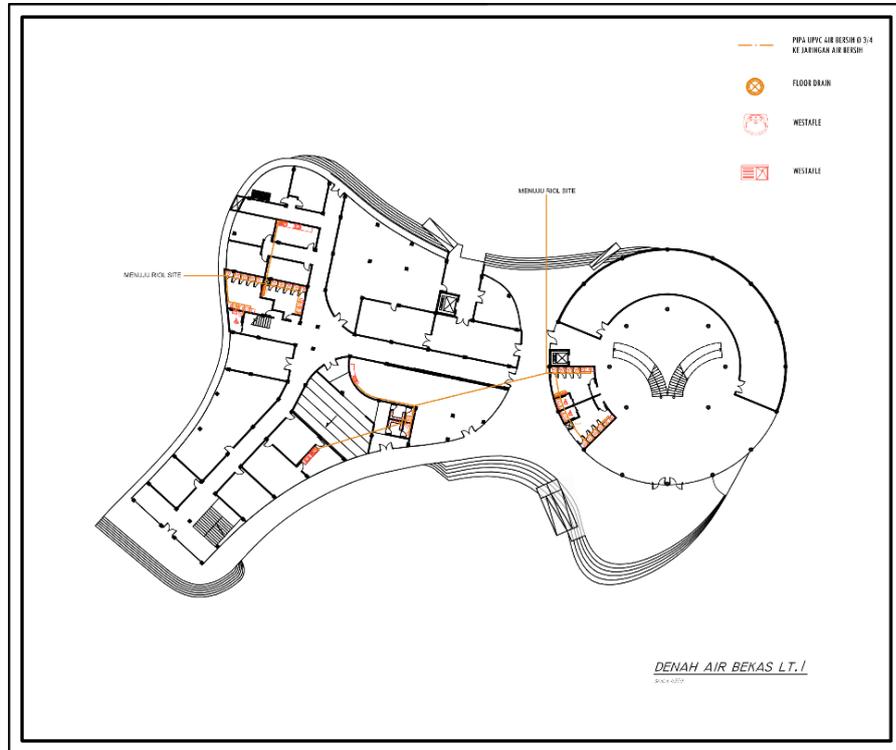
Denah Rencana Air Kotor Lantai 1
